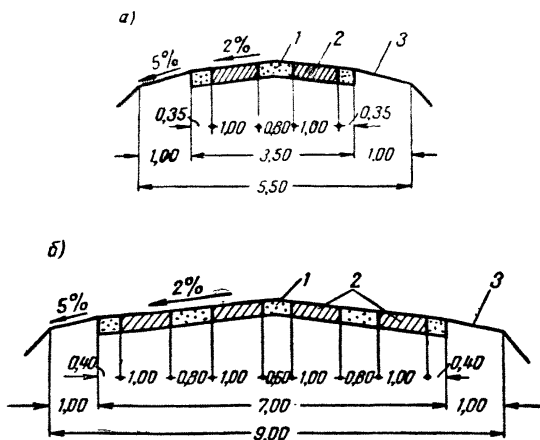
Поперечный профиль временной дороги с колейным покрытием из железобетонных плит
